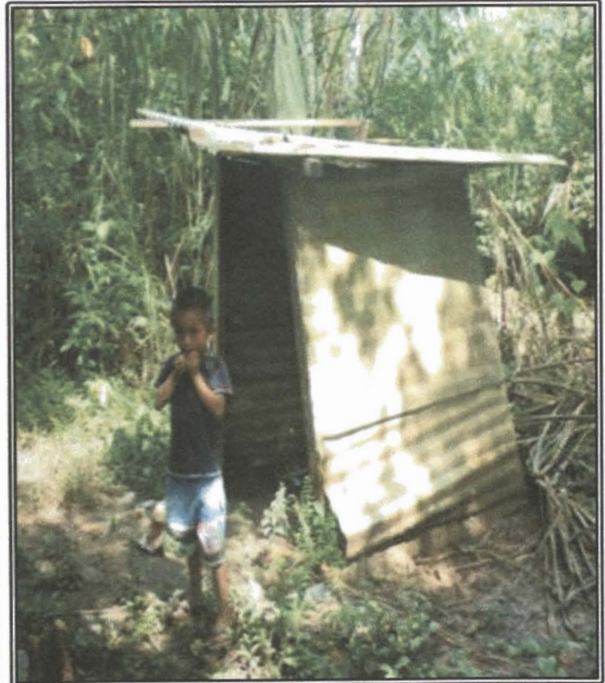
LETRINAS DE CONSTRUCCIÓN ARTESANAL
